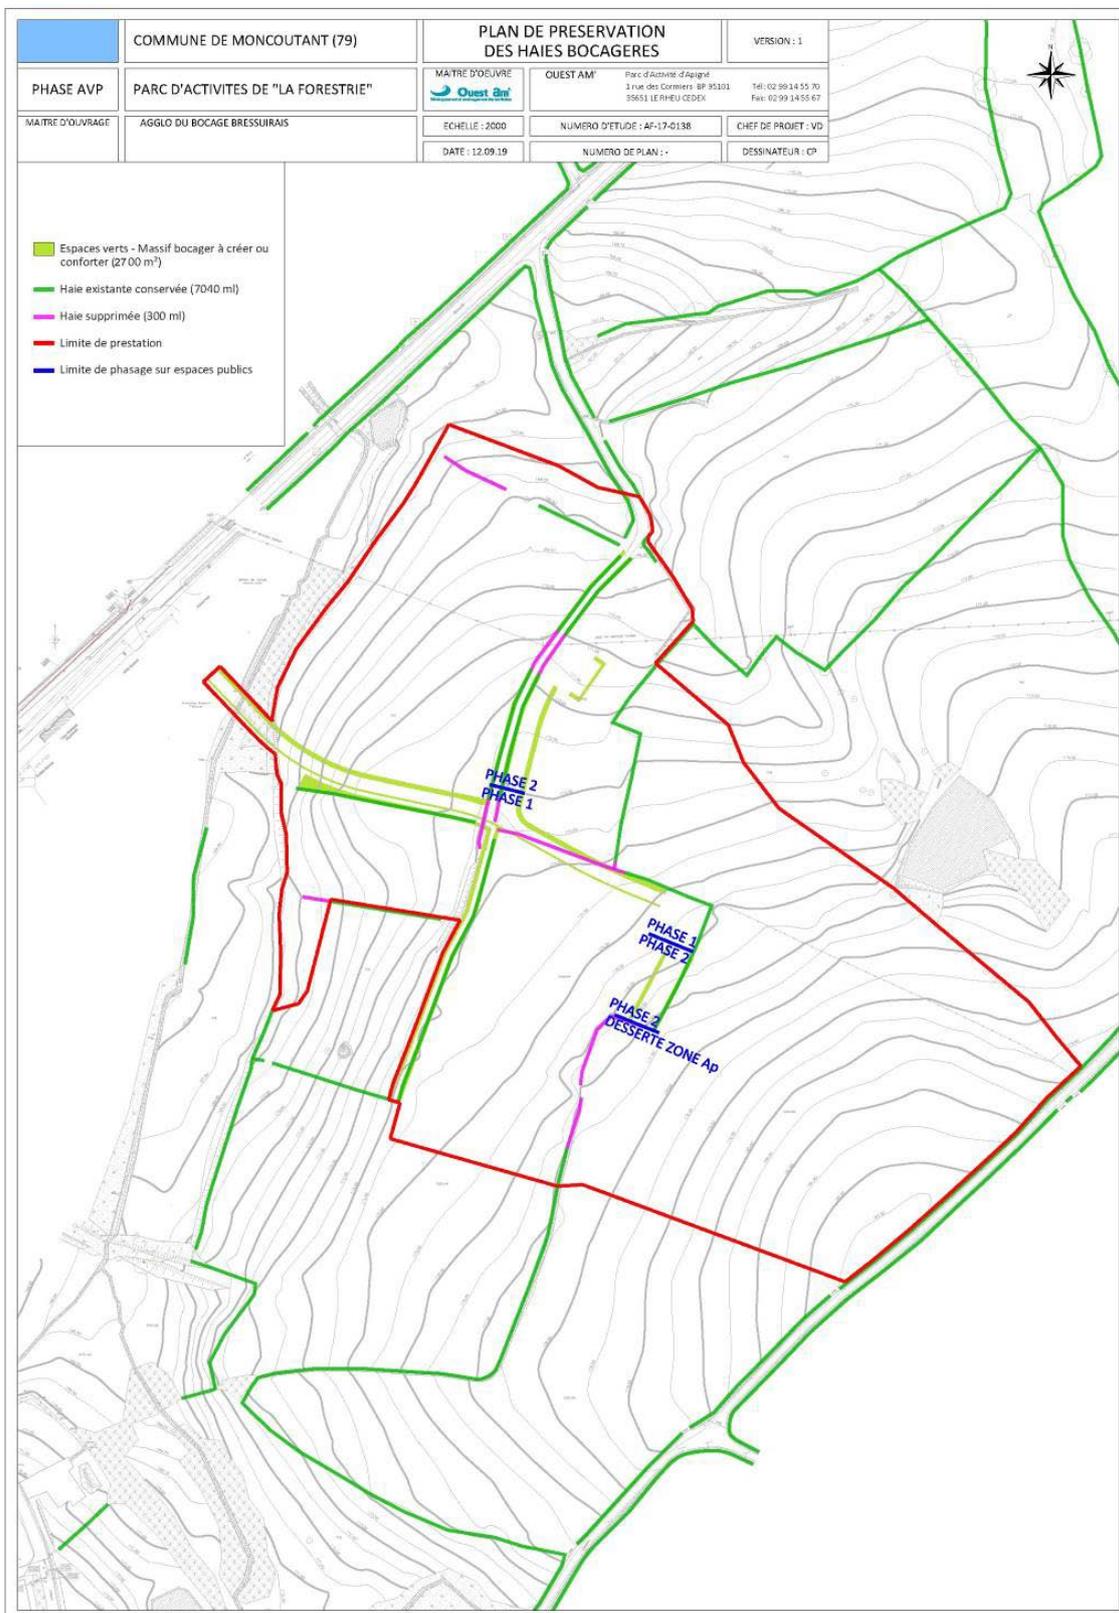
Plan de la trame bocagère du projet (Source : Ouest Am')
